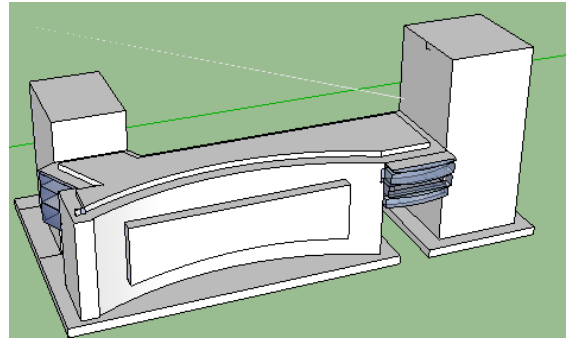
16 – 17 – 18 – 19 : Façades du Projet
